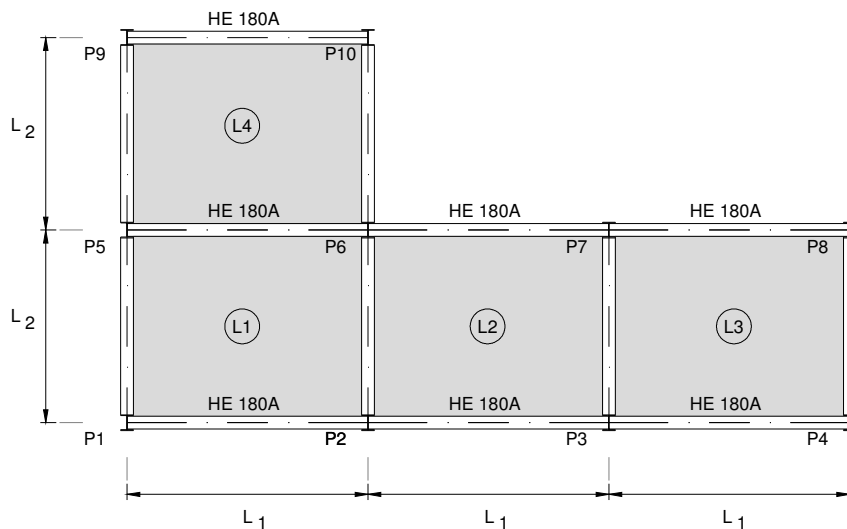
Pórtico 3D com assimetria em planta. Designação das lajes.
